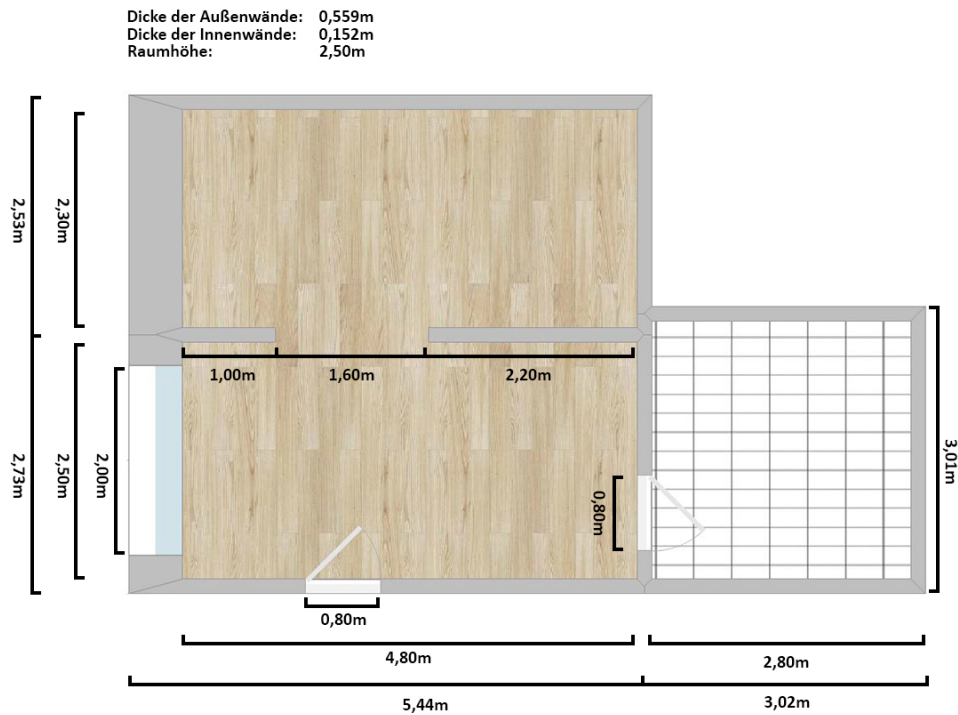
Grundriss des virtuellen Hotelzimmers
